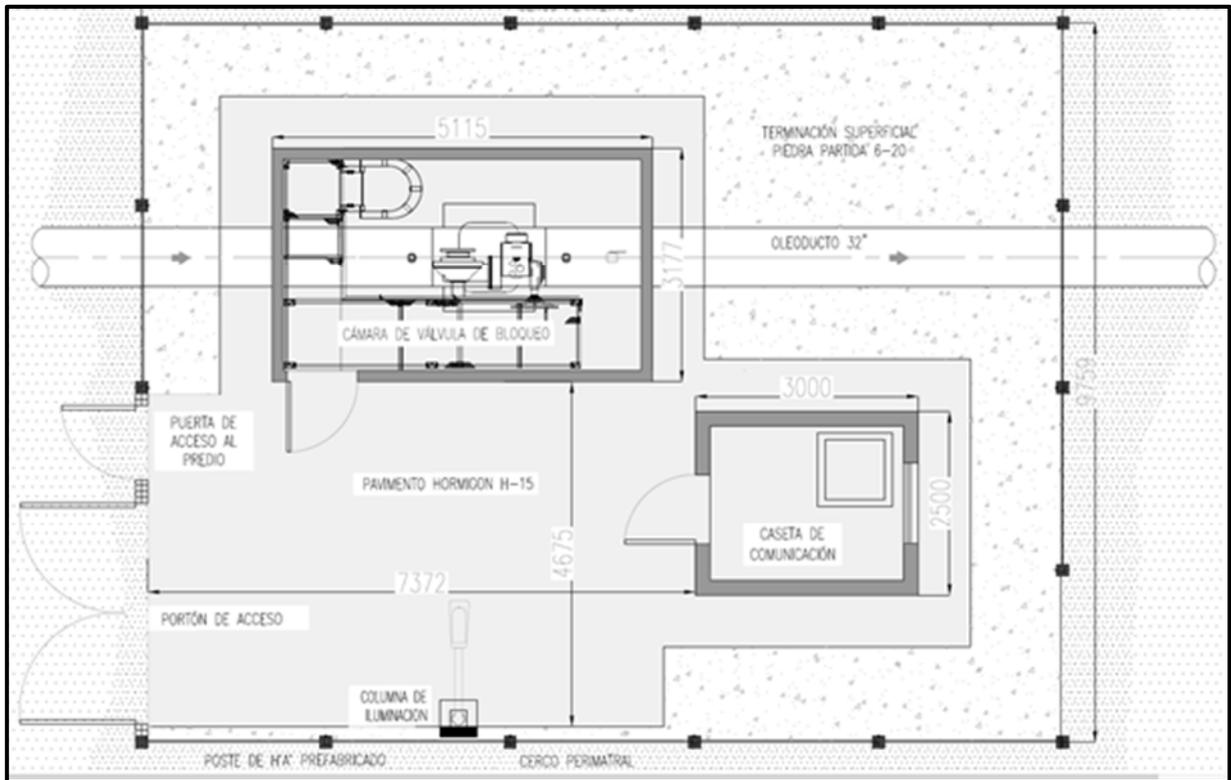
Layout de Predio Válvula de bloqueo VBL 4_9
